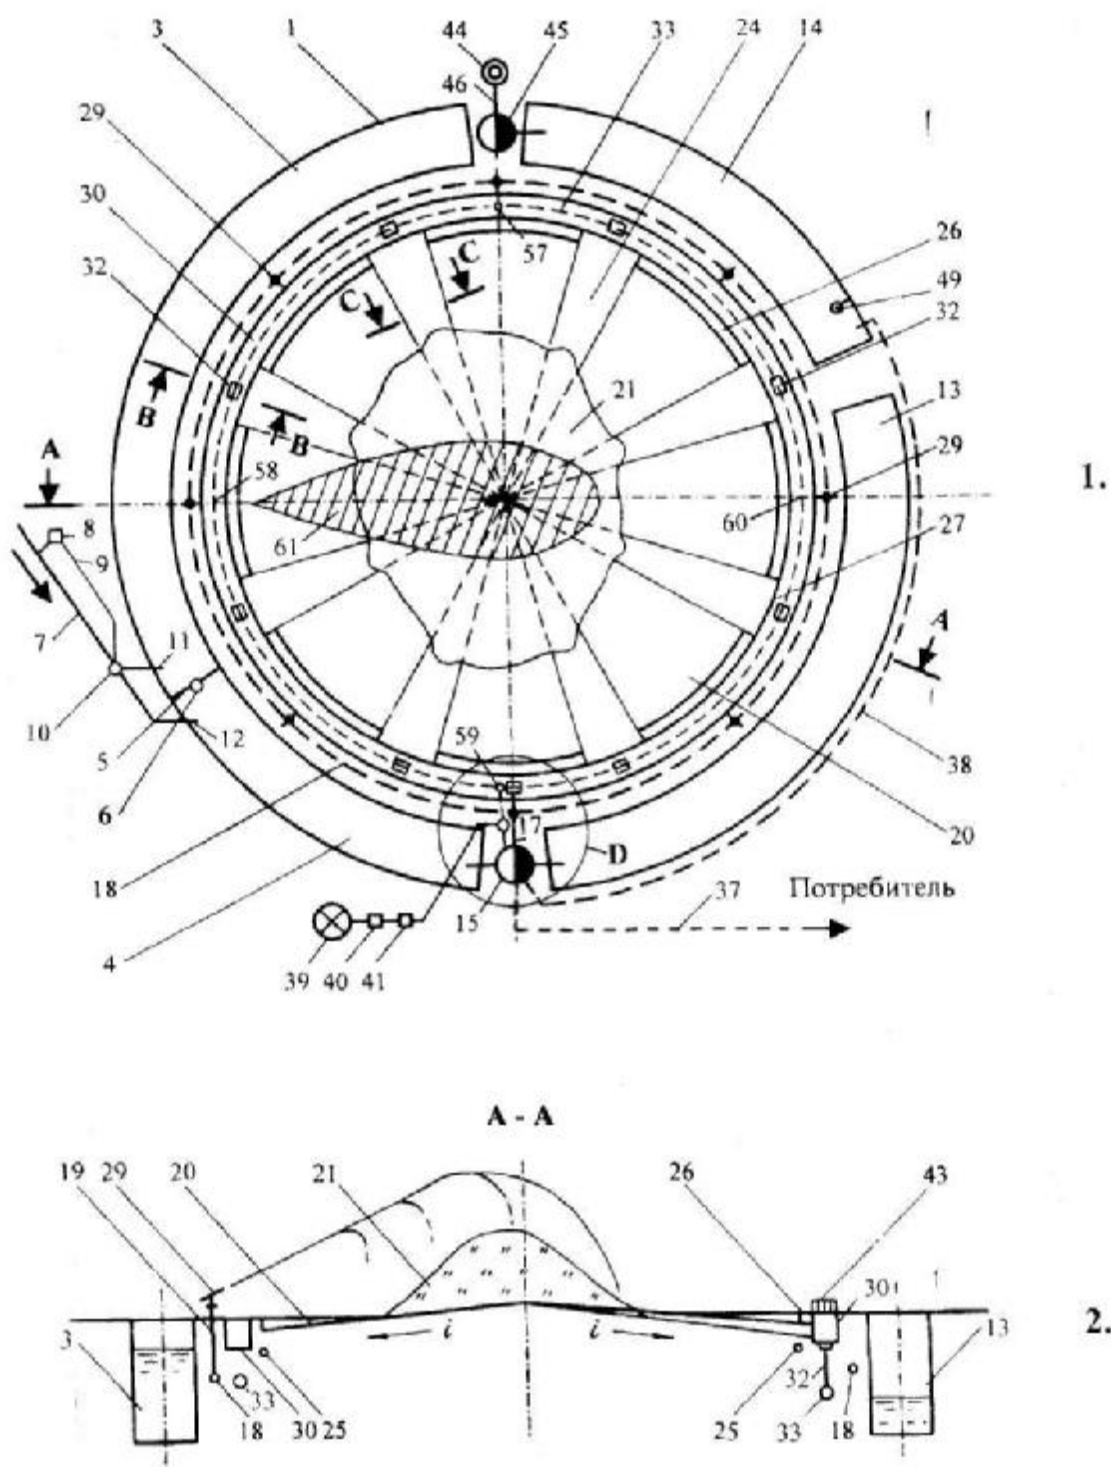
Опреснительный комплекс сооружений для условий плоского рельефа, вид в плане (1) и разрез А-А (2)
